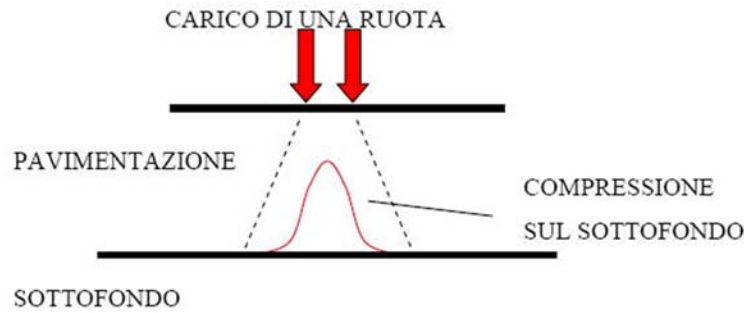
Effetti sul sottofondo di una pavimentazione con basso modulo di rigidità
